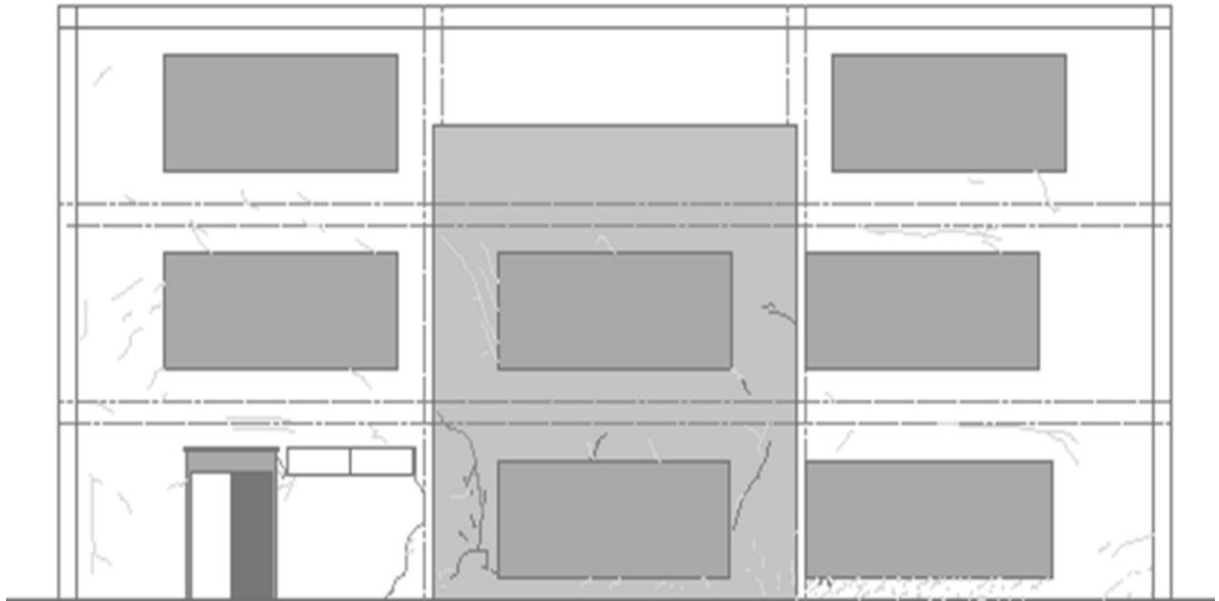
Esquema de Grietas Fachada 1. Realizada por el autor.
